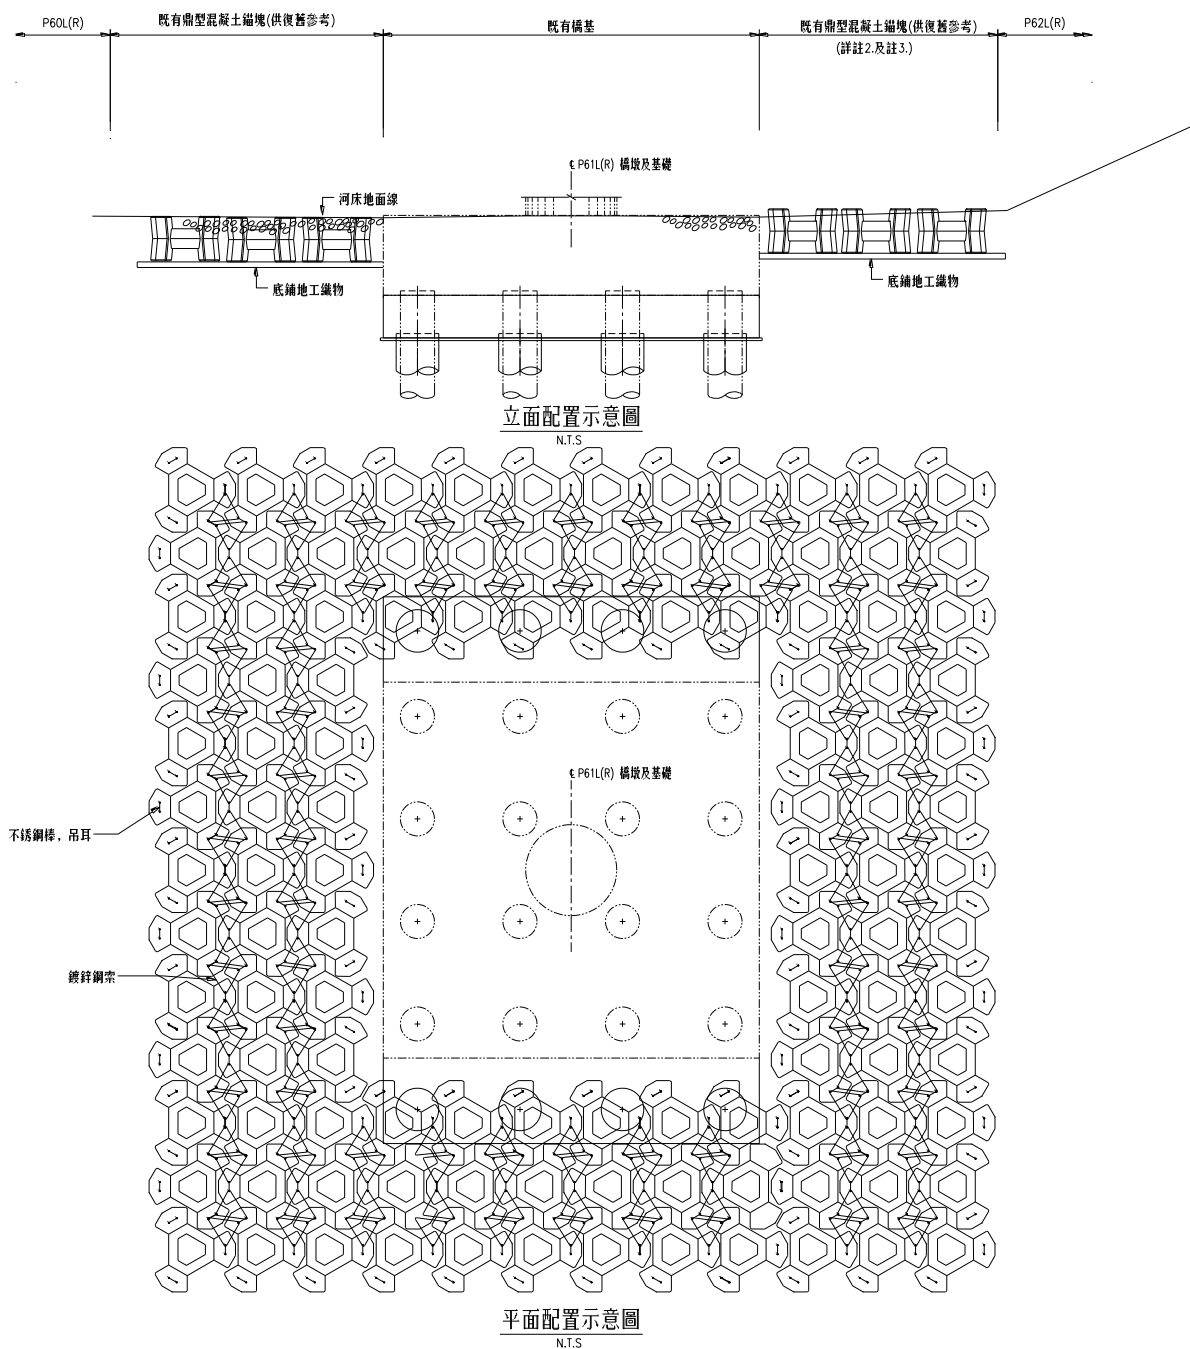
烏溪三號橋橋墩鼎型混凝土塊配置示意圖
